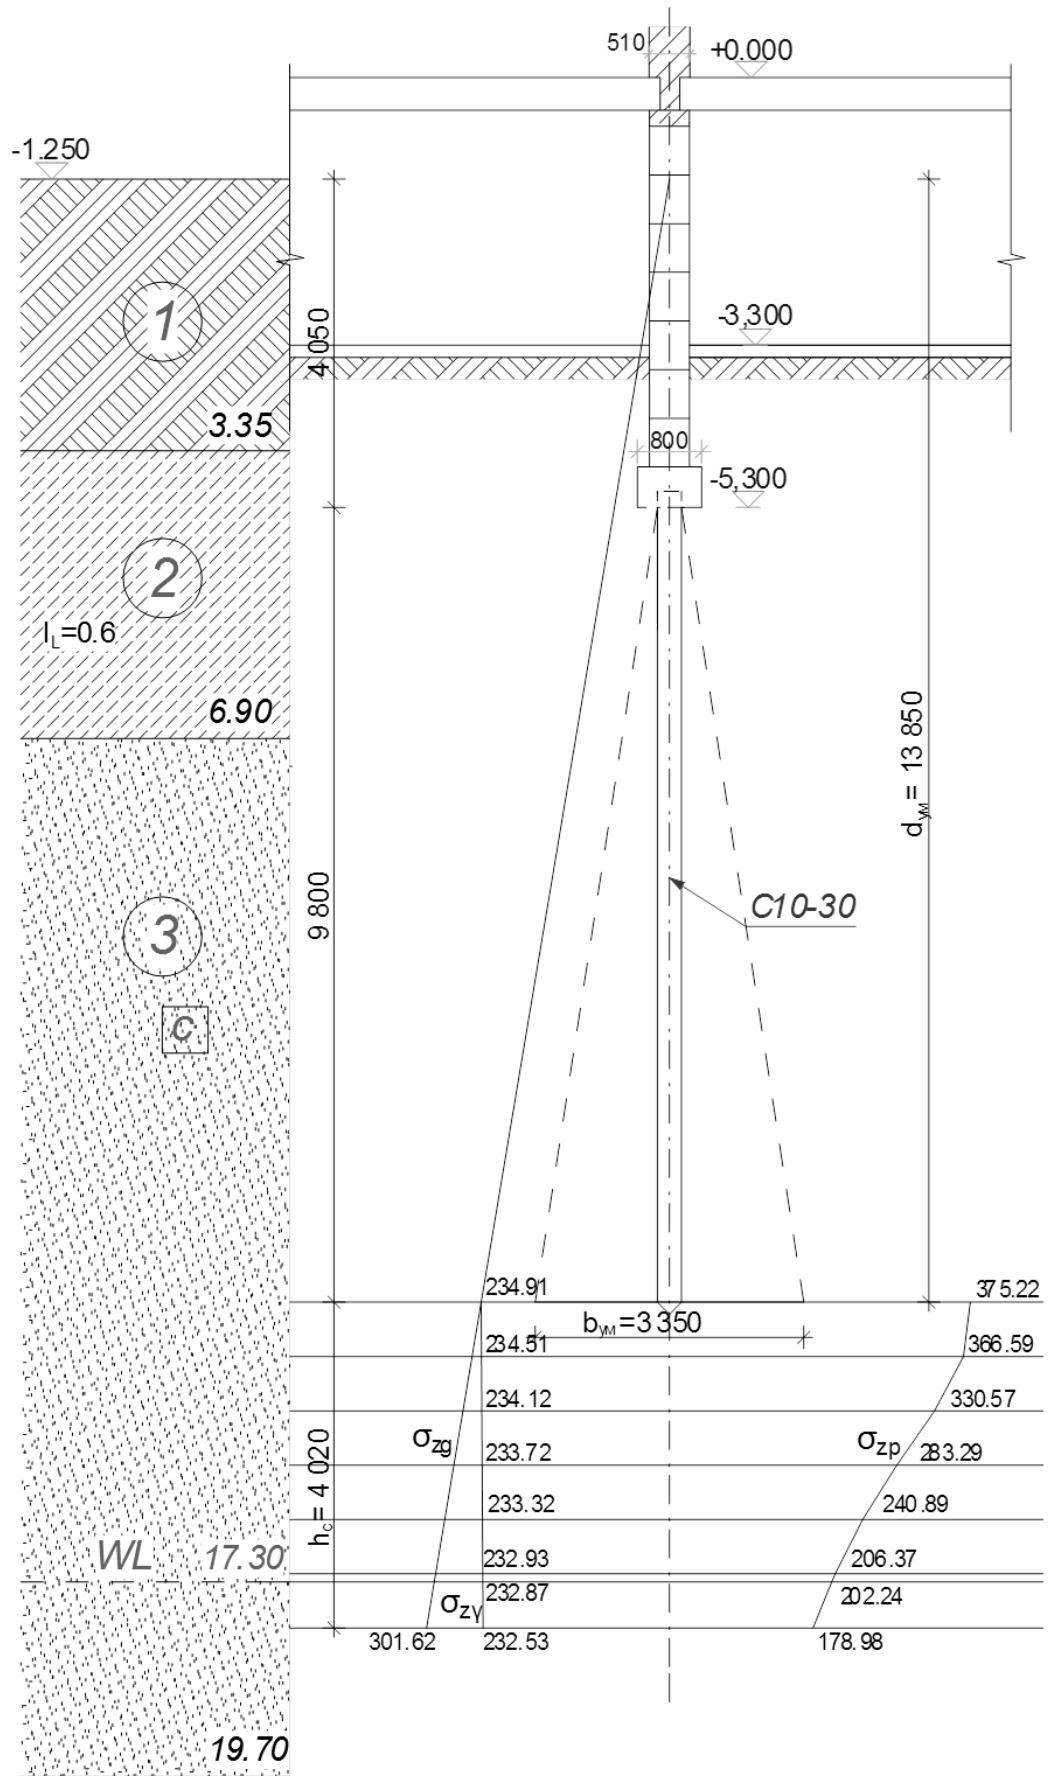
Розрахункова схема для визначення осідання пального фундаменту
